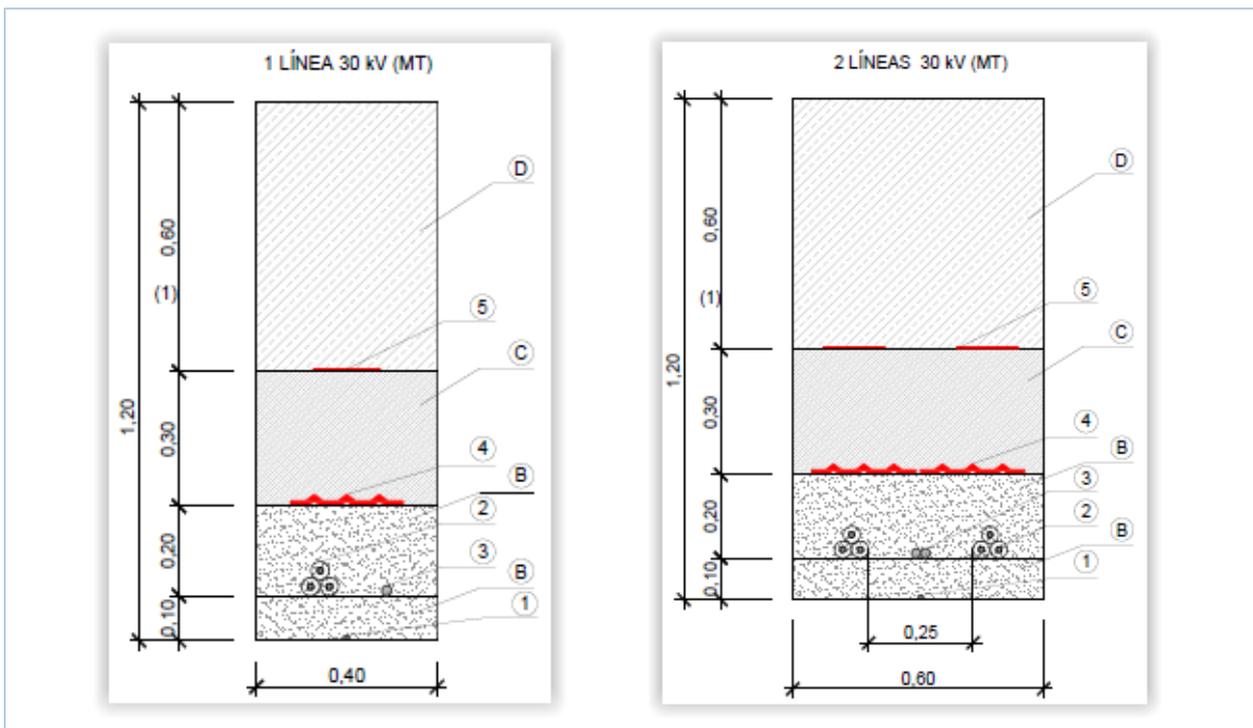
Detalle Sección Zanja. Tipo conductor directamente enterrado. (Lateral vial o por tierras) (1 de 2)
